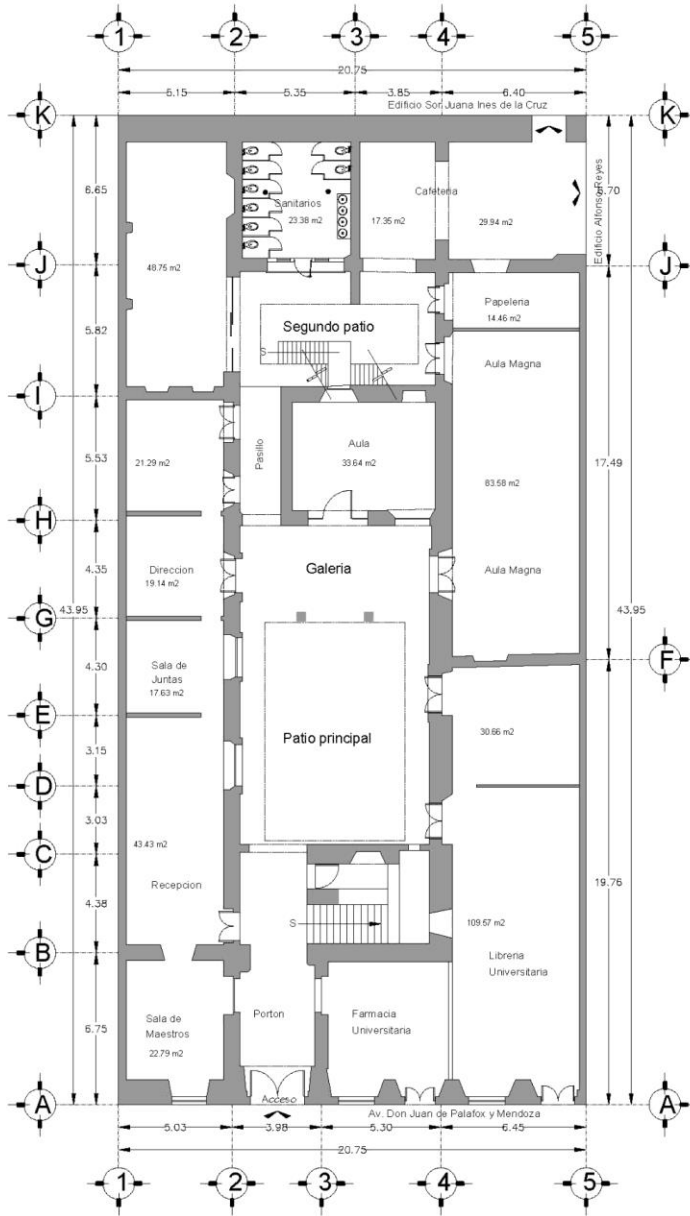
Planta baja del edificio Ricardo Flores Magón. Elaboración propia
